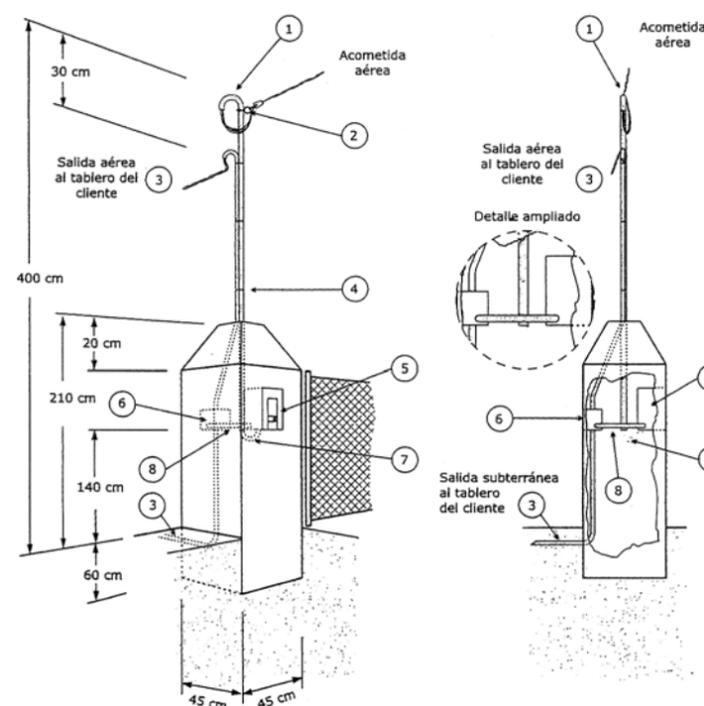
Acometida aérea, tarifa T1 de Edenor. Pilar de mampostería con el caño pilar
